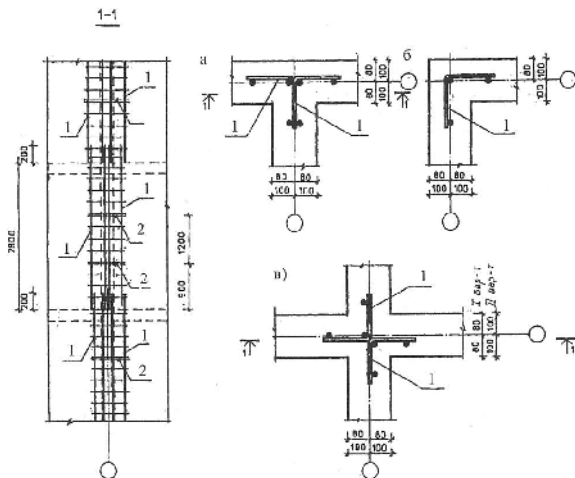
Армирование вертикальных узлов сопряжения бетонных массивных стен при их одновременном бетонировании: а – Т-образное; б – угловое и в – крестобразное; 1 – гнутый арматурный каркас; 2 – отдельные стержни
